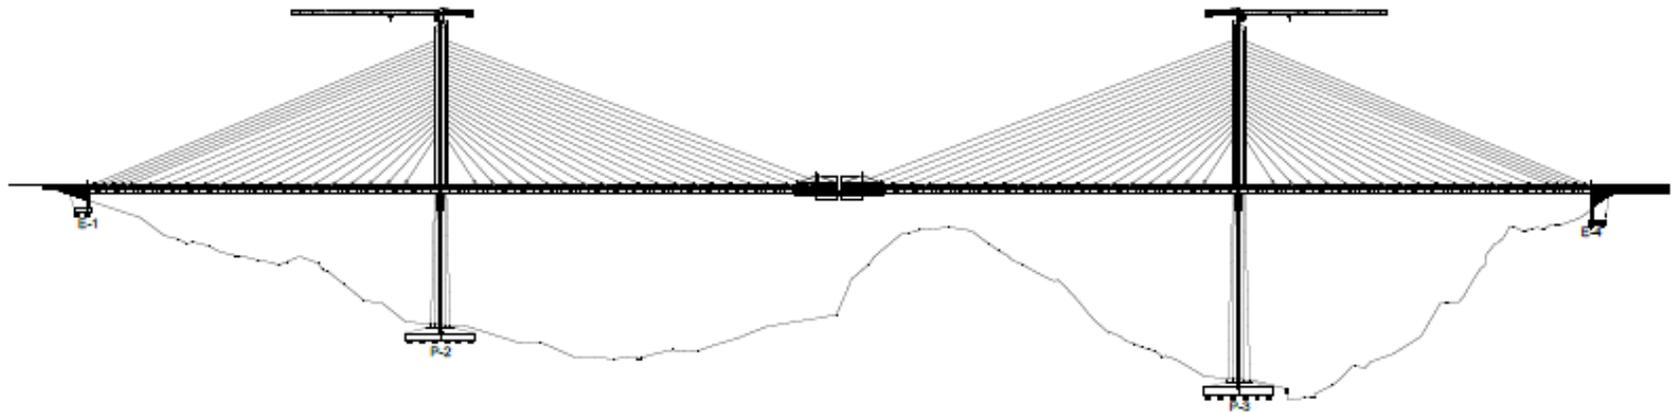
Fase 11: Desmontaje de carro y colocación del otro carro para construcción de Dovela de cierre.
